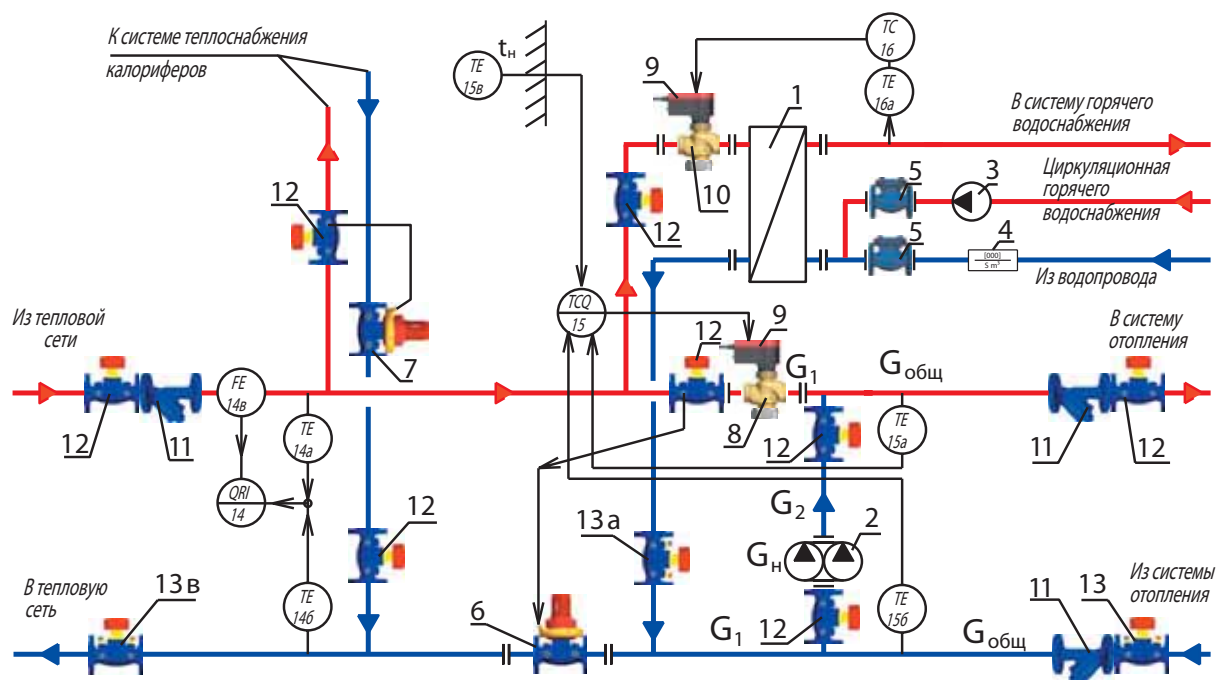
Схема ИТП с узлом смешения при установке смесительного насоса на перемычке
